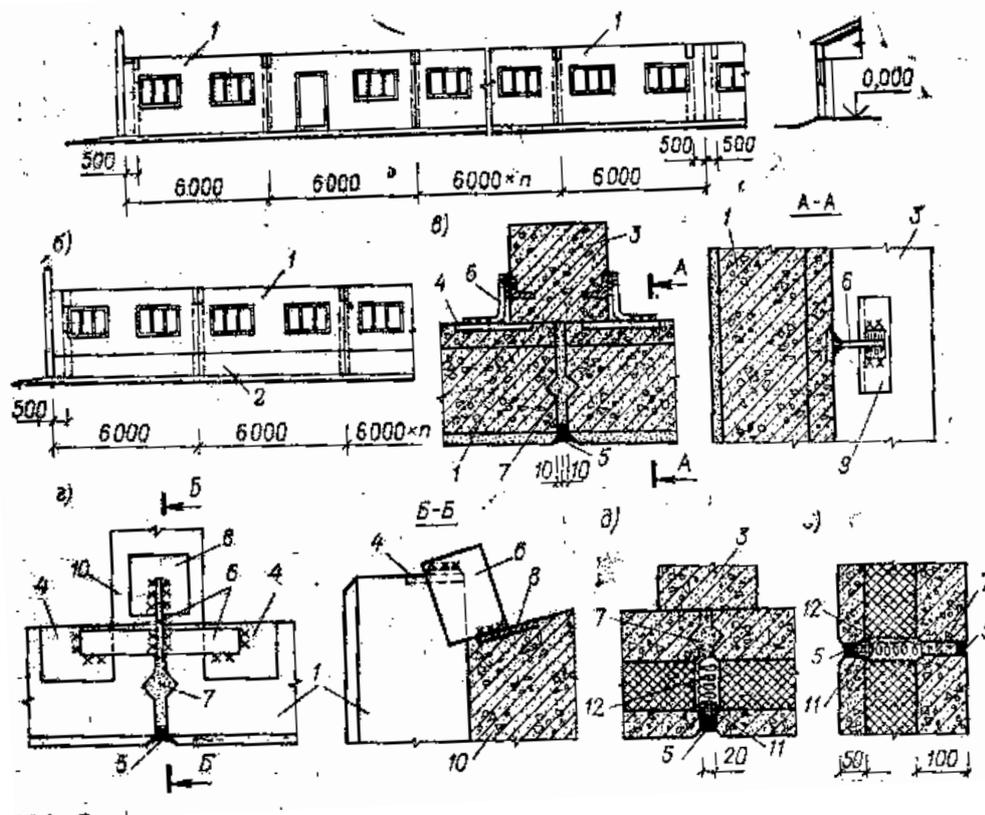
Стены из панелей повышенной заводской готовности: а – схема разрезки продольной стены высотой до 3,3 м; б – то же, высотой 3; 3,3; 3,6 м; в – крепление панелей к колонне каркаса; г – крепление панелей к стропильной конструкции; д, е – устройство стыков трехслойных панелей; 1 – панель повышенной заводской готовности; 2 – горизонтальная панель; 3 – колонная каркаса; 4 – закладная деталь панели; 5 – мастика УМС-50; 6 - соединительный элемент; 7 – плотный цементный раствор марки 100; 8 – закладная деталь стропильной конструкции; 9 – закладная деталь колонны; 10 – стропильная конструкция; 11 – эластичная герметизирующая прокладка; 12 – минераловатный утеплитель
